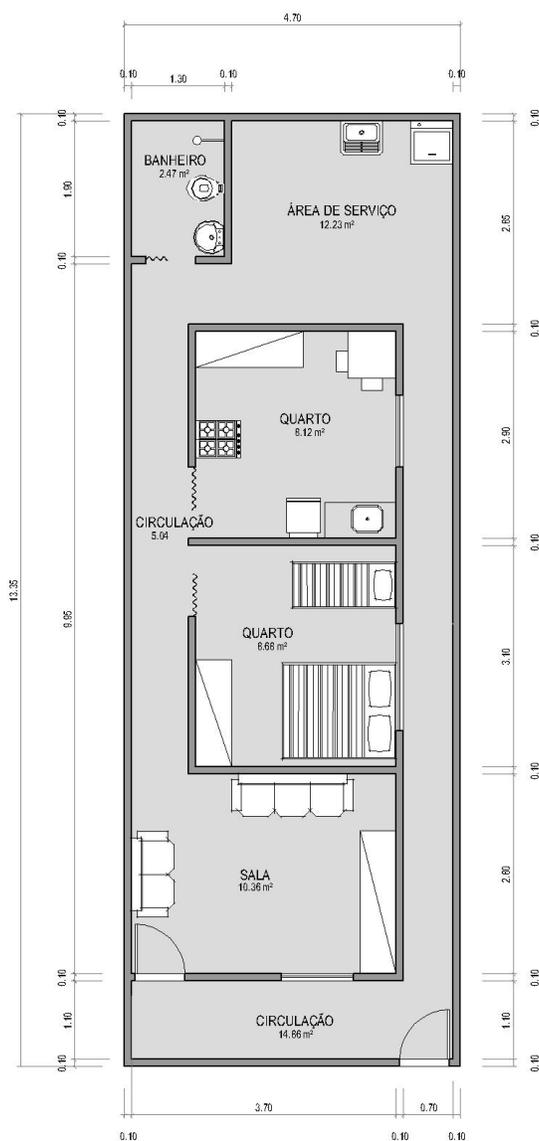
Planta baixa da casa da Sra. Aurélia. Área: 61,24 m².
